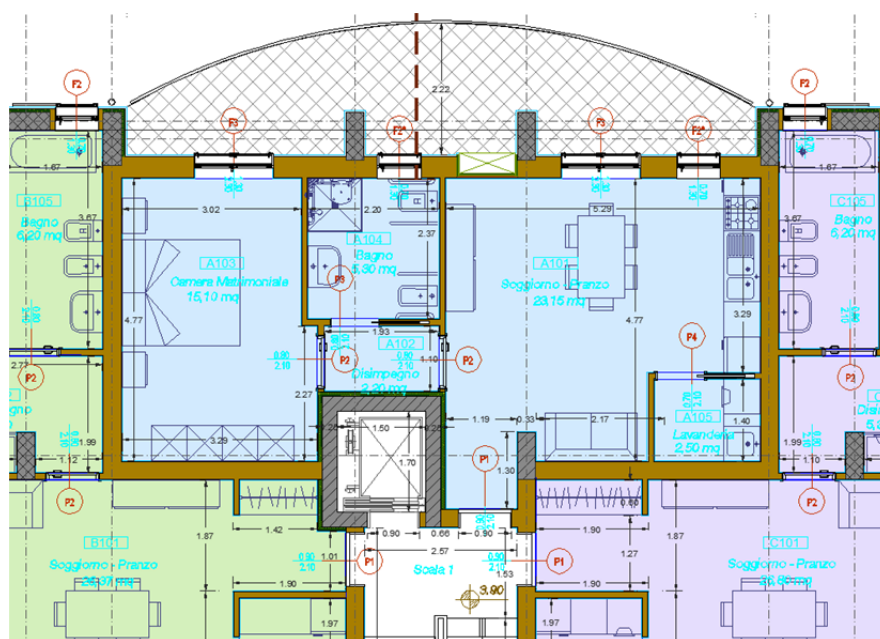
Piano Primo appartamento tipo A, progetto esecutivo.
